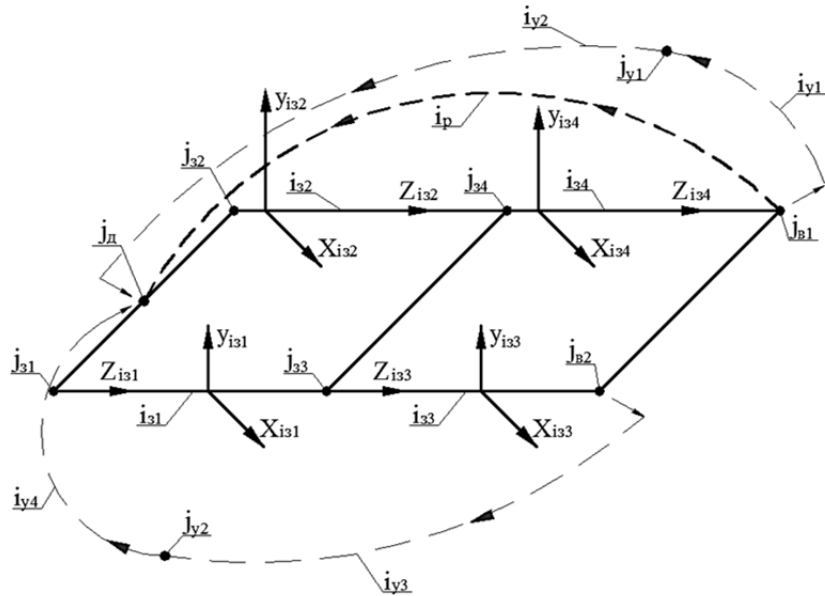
Система повітряного (газоповітряного) теплопостачання з трубчастими газовими нагрівачами, розташованими у будівельних конструкціях: /Air (gas) heating system with tube gas heaters located in structures: x_i та y_i – координати у перетині будівельної конструкції; z_i – координата по довжині нагрівача; j_0 – вузол джерела; j_s – вузол з'єднань; j_e – вузол витоків; j_y – вузол умовної ділянки; i_s – ділянка з'єднань; i_y – умовна ділянка; i_p – ділянка рециркуляції.
